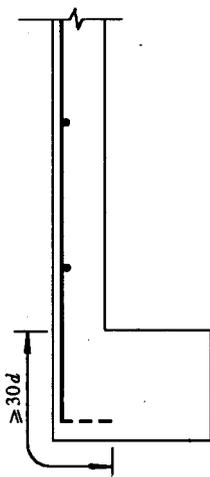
板上部钢筋焊接网与混凝土梁（边跨）的连接
